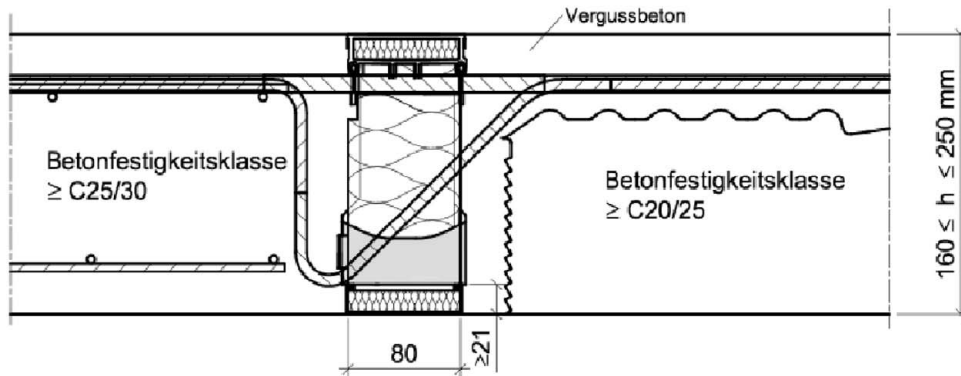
Beispiel Schöck Isokorb® T Typ K-ID mit Betondrucklager bei indirekter Lagerung
